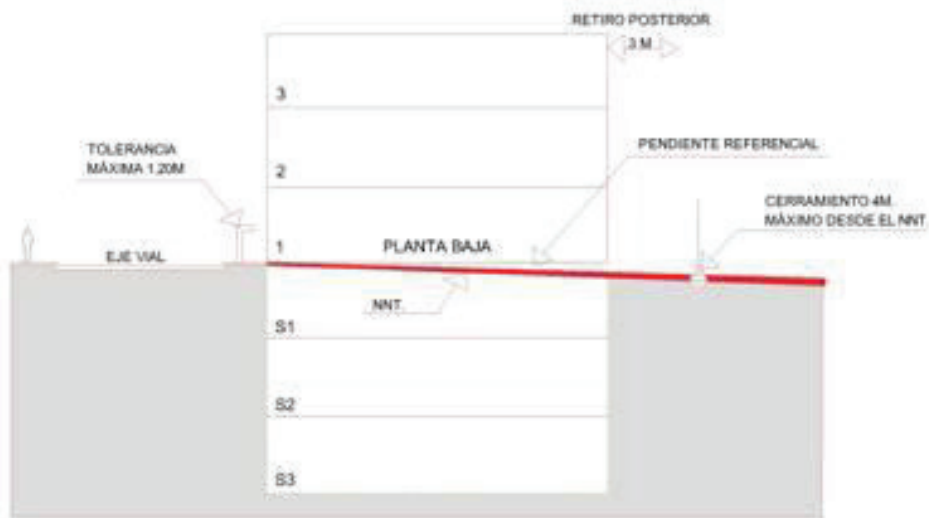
Definición de Planta Baja en Terreno Plano sobre línea de fábrica
